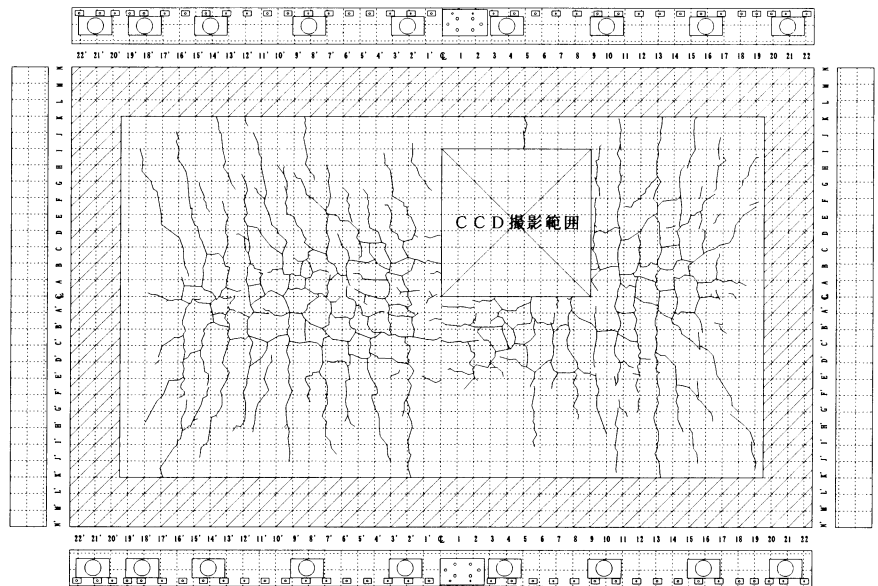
輪荷重走行試験終了時におけるひび割れ発生状況(供試体下面)
